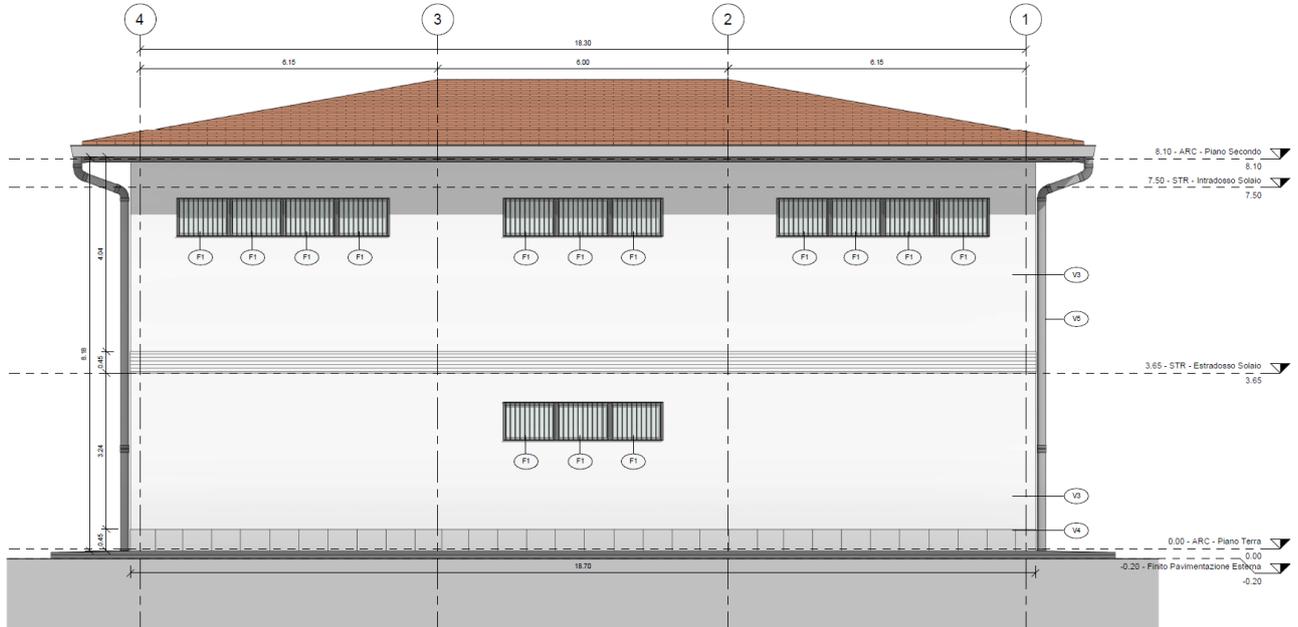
PPM Pieve Emanuele – Prospetto Sud-Est (Opposto ai Binari)
